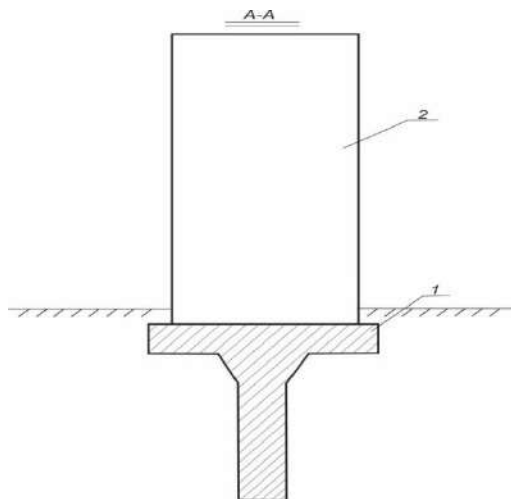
Фундамент высотных зданий с сооружений, возводимых на просадочных грунтах.
